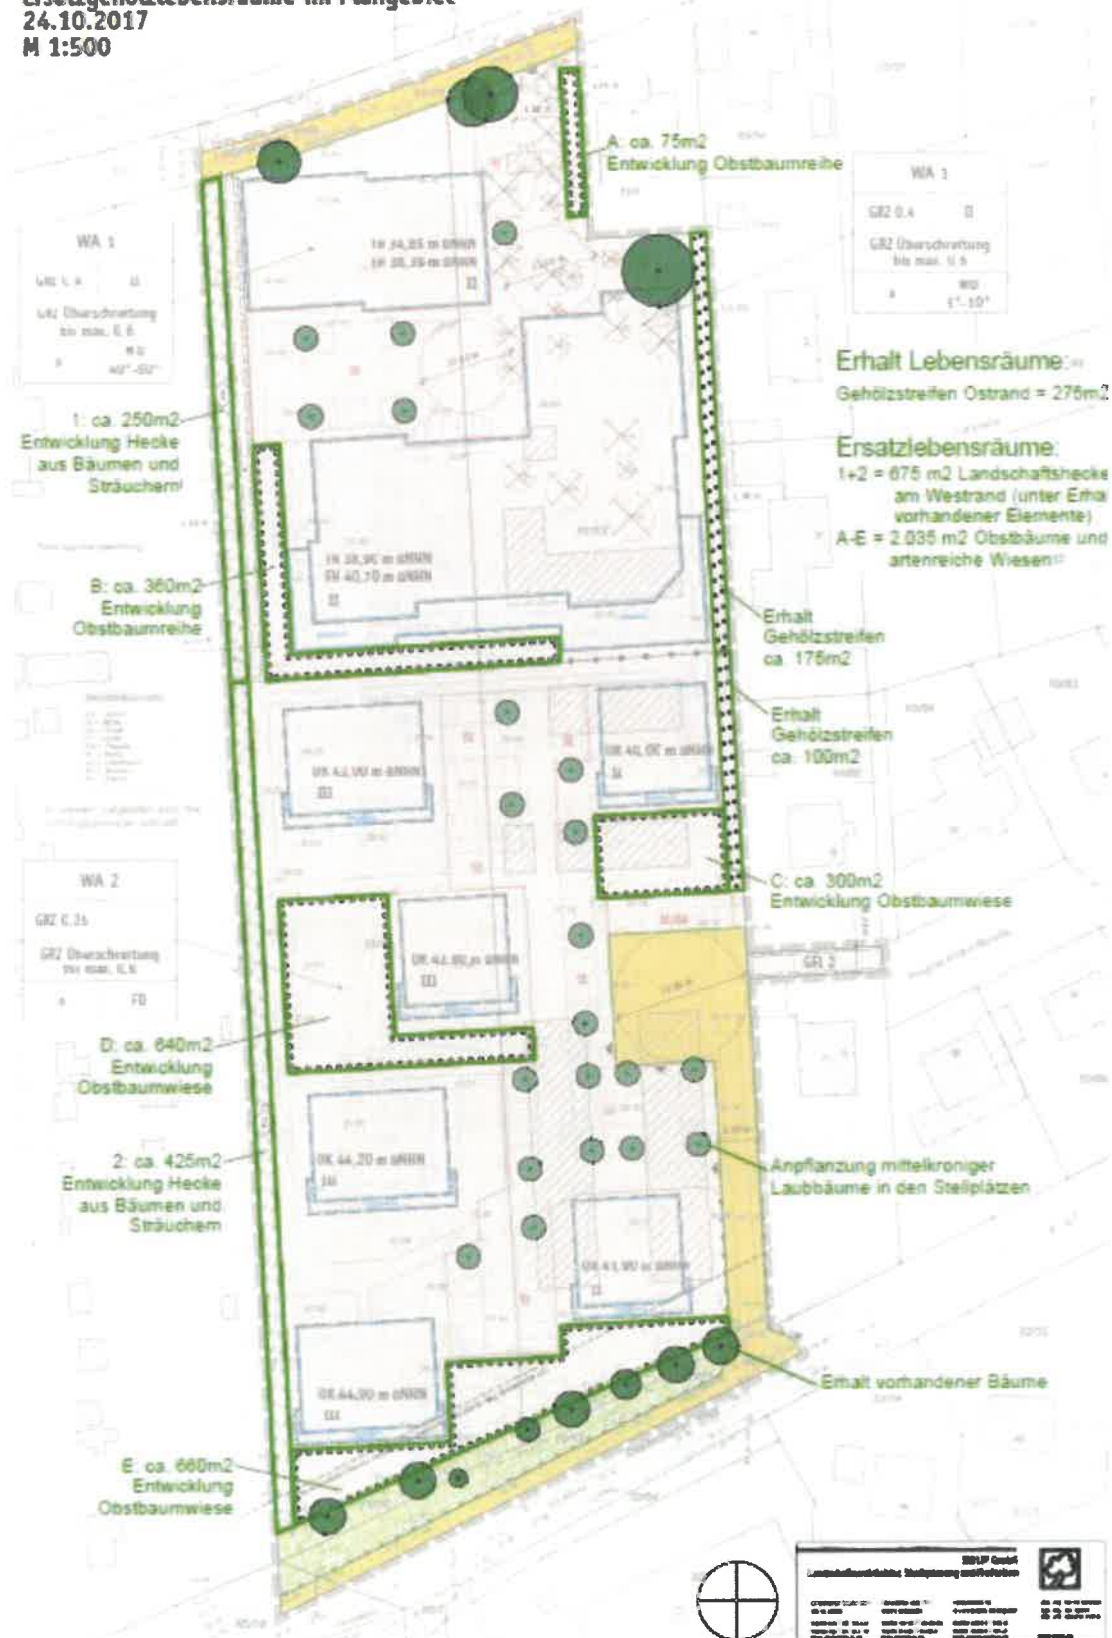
Planzeichnung Ersatzgehölze Büro SWUP GmbH
